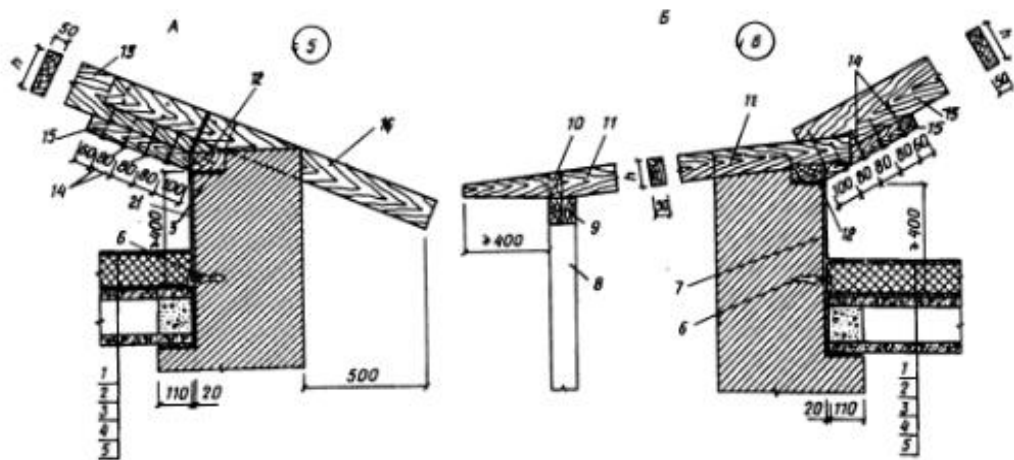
Узлы 5-6 несущих конструкций крыши: А – опирание стропильных ног крыши на стену здания; Б – опирание стропильных ног крыши здания и примыкающей веранды на стену здания; 1 – шлако-известковая юбка; 2 – утеплитель; 3 – слой пергамина или прокладочного рубероида; 4 – слой цементного раствора; 5 – панель перекрытия; 6 – ерш; 7 – скрутка; 8 – стойка веранды; 9 – прогон крыши веранды; 10 – вставка между стропилами веранды; 11 – стропильные ноги крыши веранды; 12 – мауэрлат; 13 – стропильная нога; 14 – гвозди; 15 – опорный брус; 16 – кобылка
